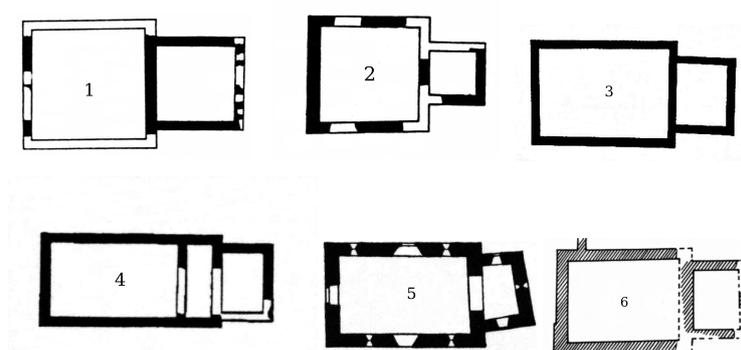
Grundrisse von Steinkirchen mit oder ohne Rechteckchor (nicht maßstabsgerecht).
